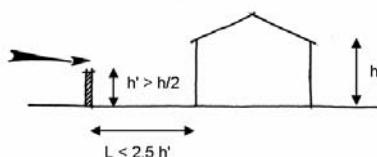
Dimensions et implantation d'un mur de protection.
